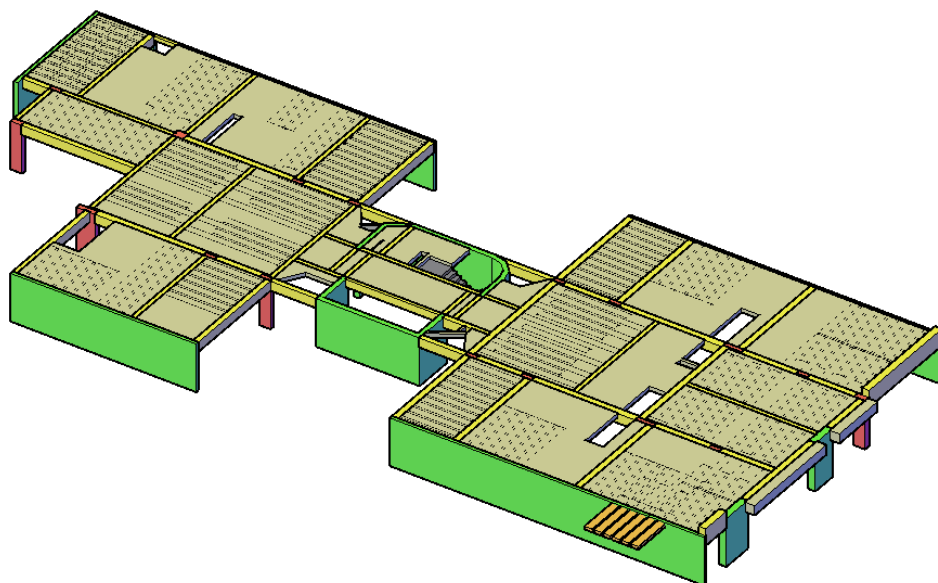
Elementos estructurales modelados en 3D-Autocad.
